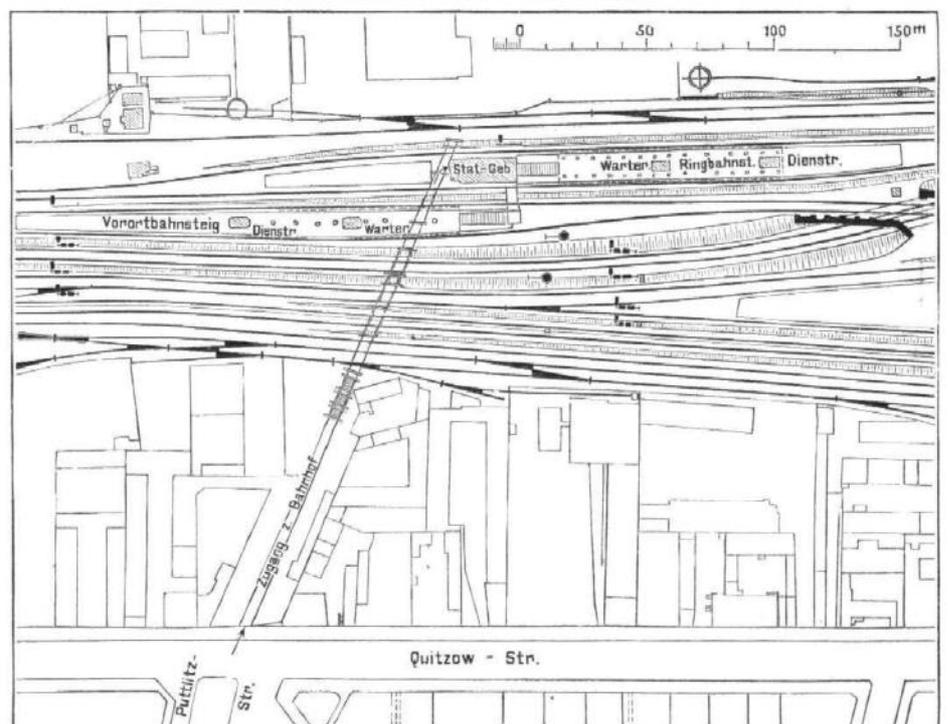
Bahnhof Putlitzstraße. Lageplan.
